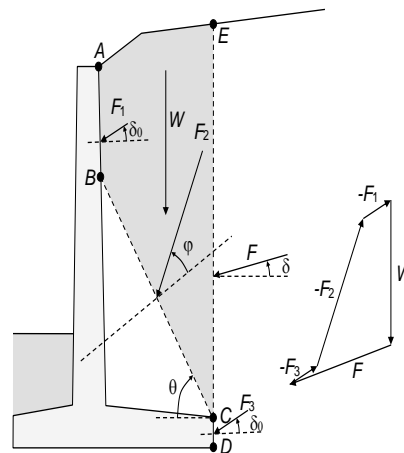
Équilibre du sol situé entre le parement fictif vertical et le plan de glissement
